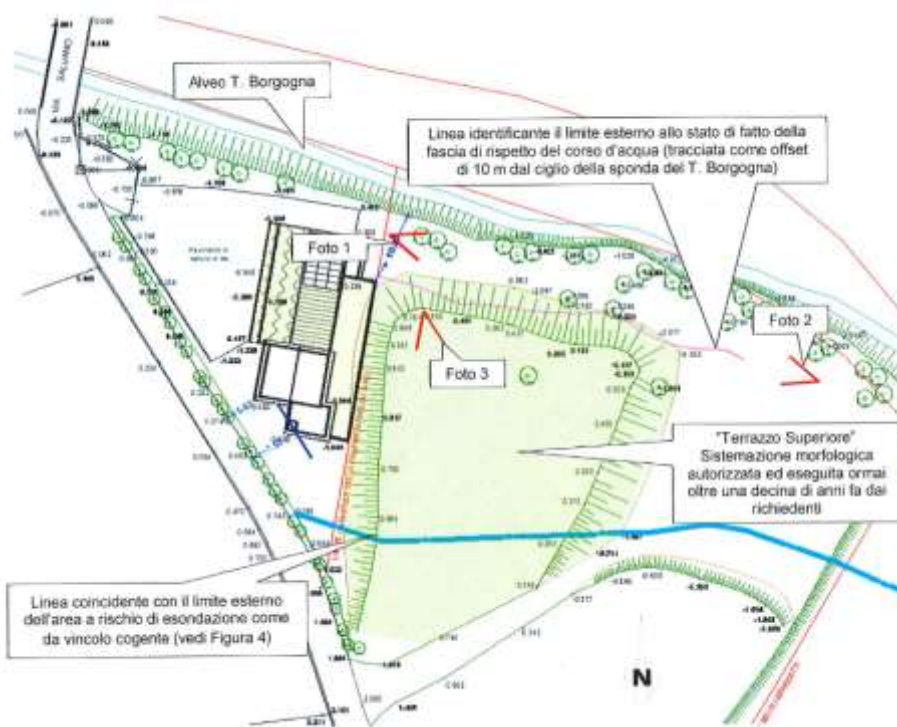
Planimetria dell'area con individuazione della fascia di rispetto di 10 m del corso d'acqua e perimetro esterno dell'area a rischio di esondazione come da vincolo cogente (da Tecno.Geo)
